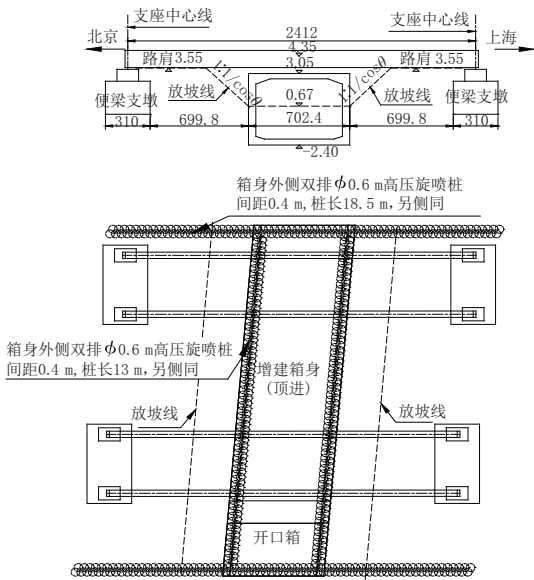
北京侧下穿京沪铁路基坑平面图(单位:mm)
